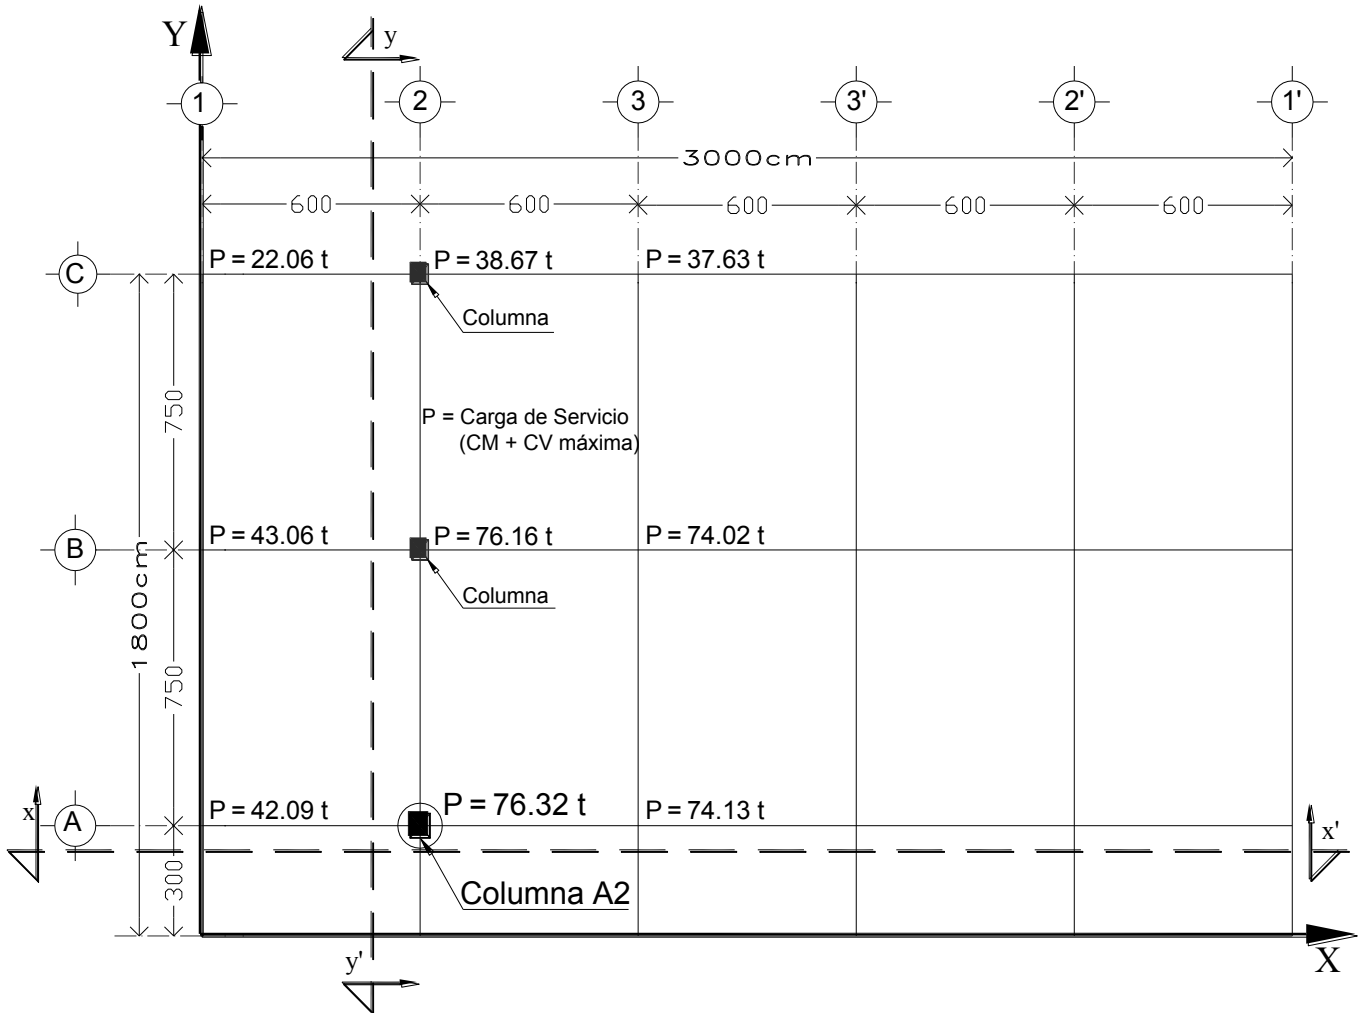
Localización en planta de la columna A2 y del corte longitudinal (x - x') y corte transversal (y - y') del ejemplo 6.1
